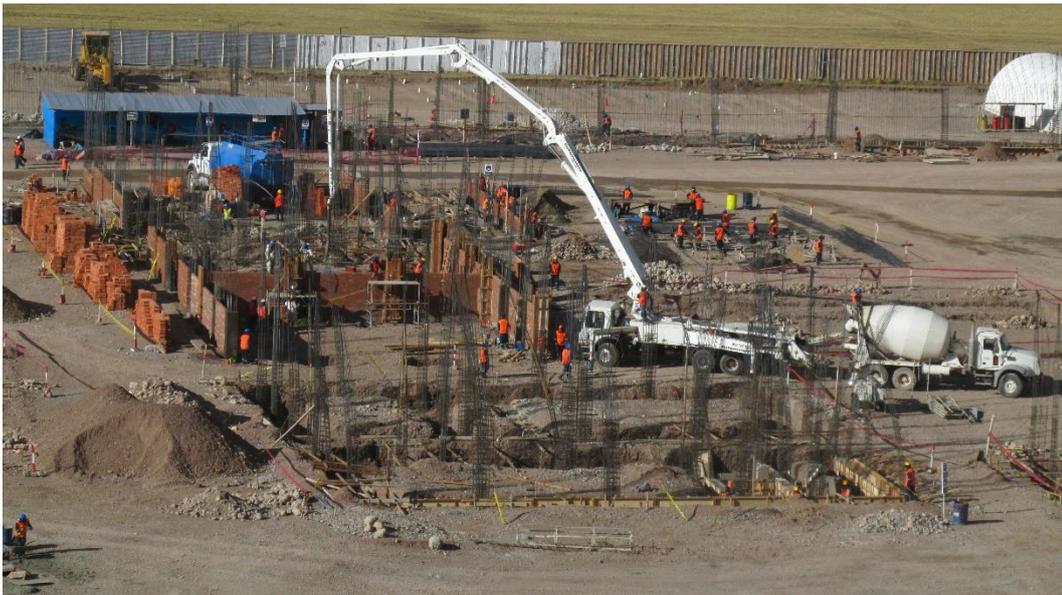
Trabajos de vertido de concreto con planta de concreto.
